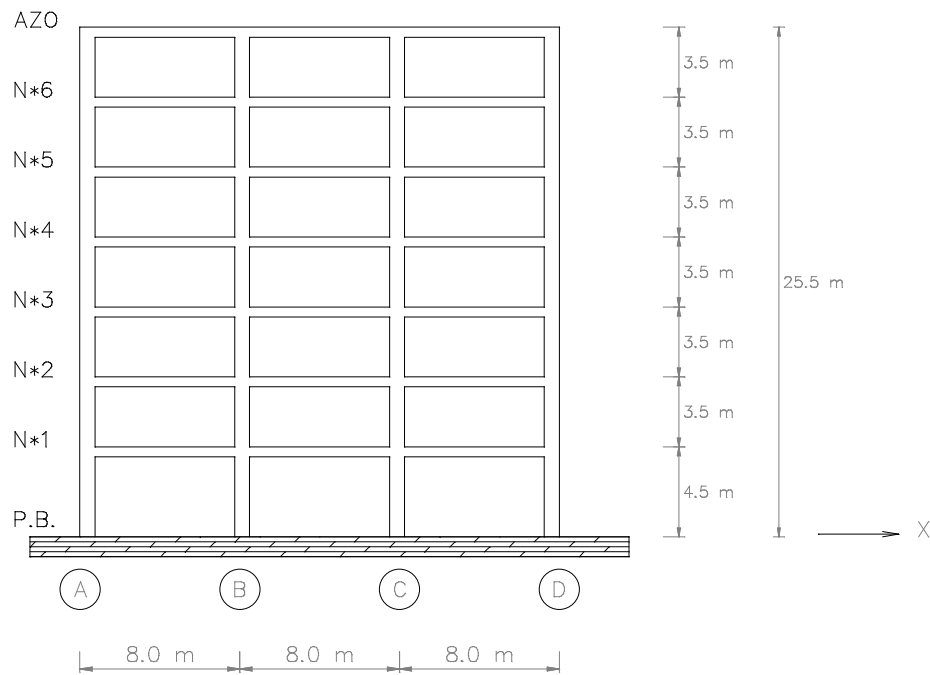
Corte en elevación de la estructura de 7 niveles
